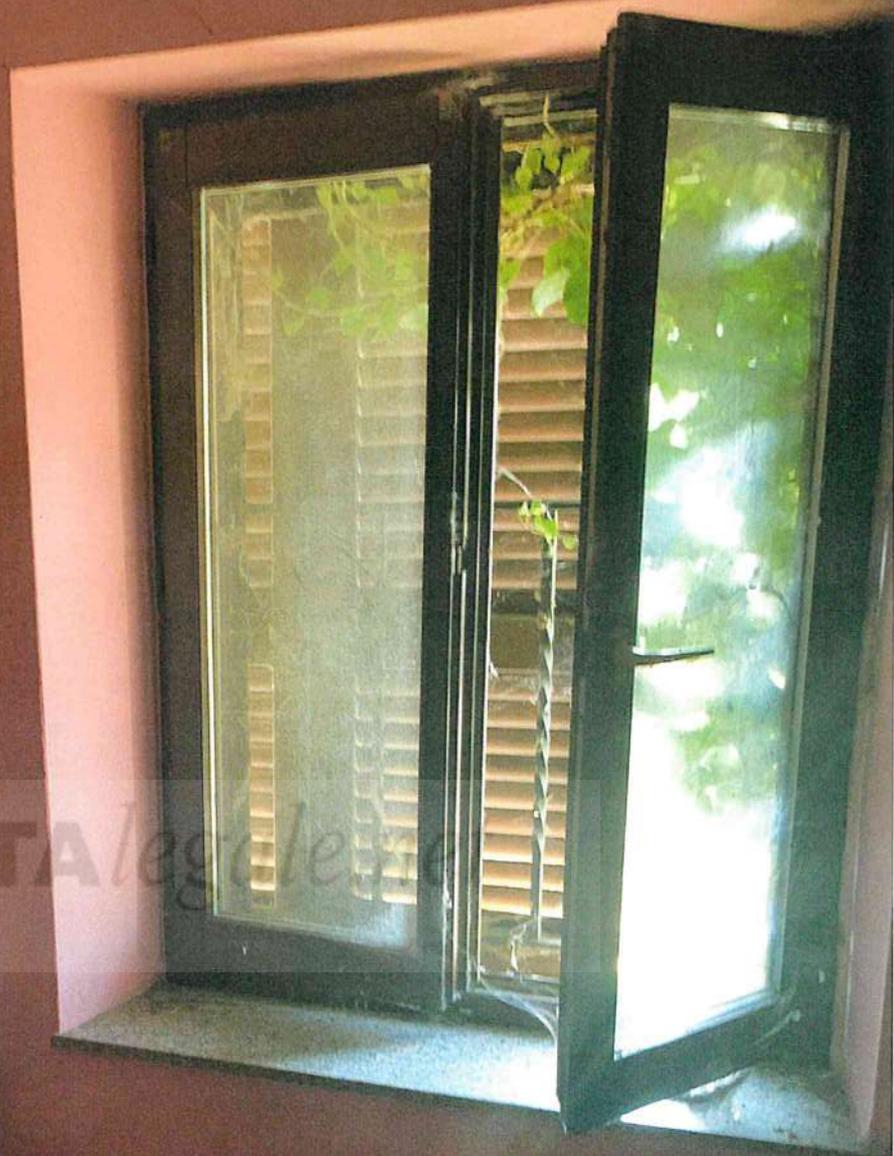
ALTRA CAMERA DA LETTO AL 1° F.
